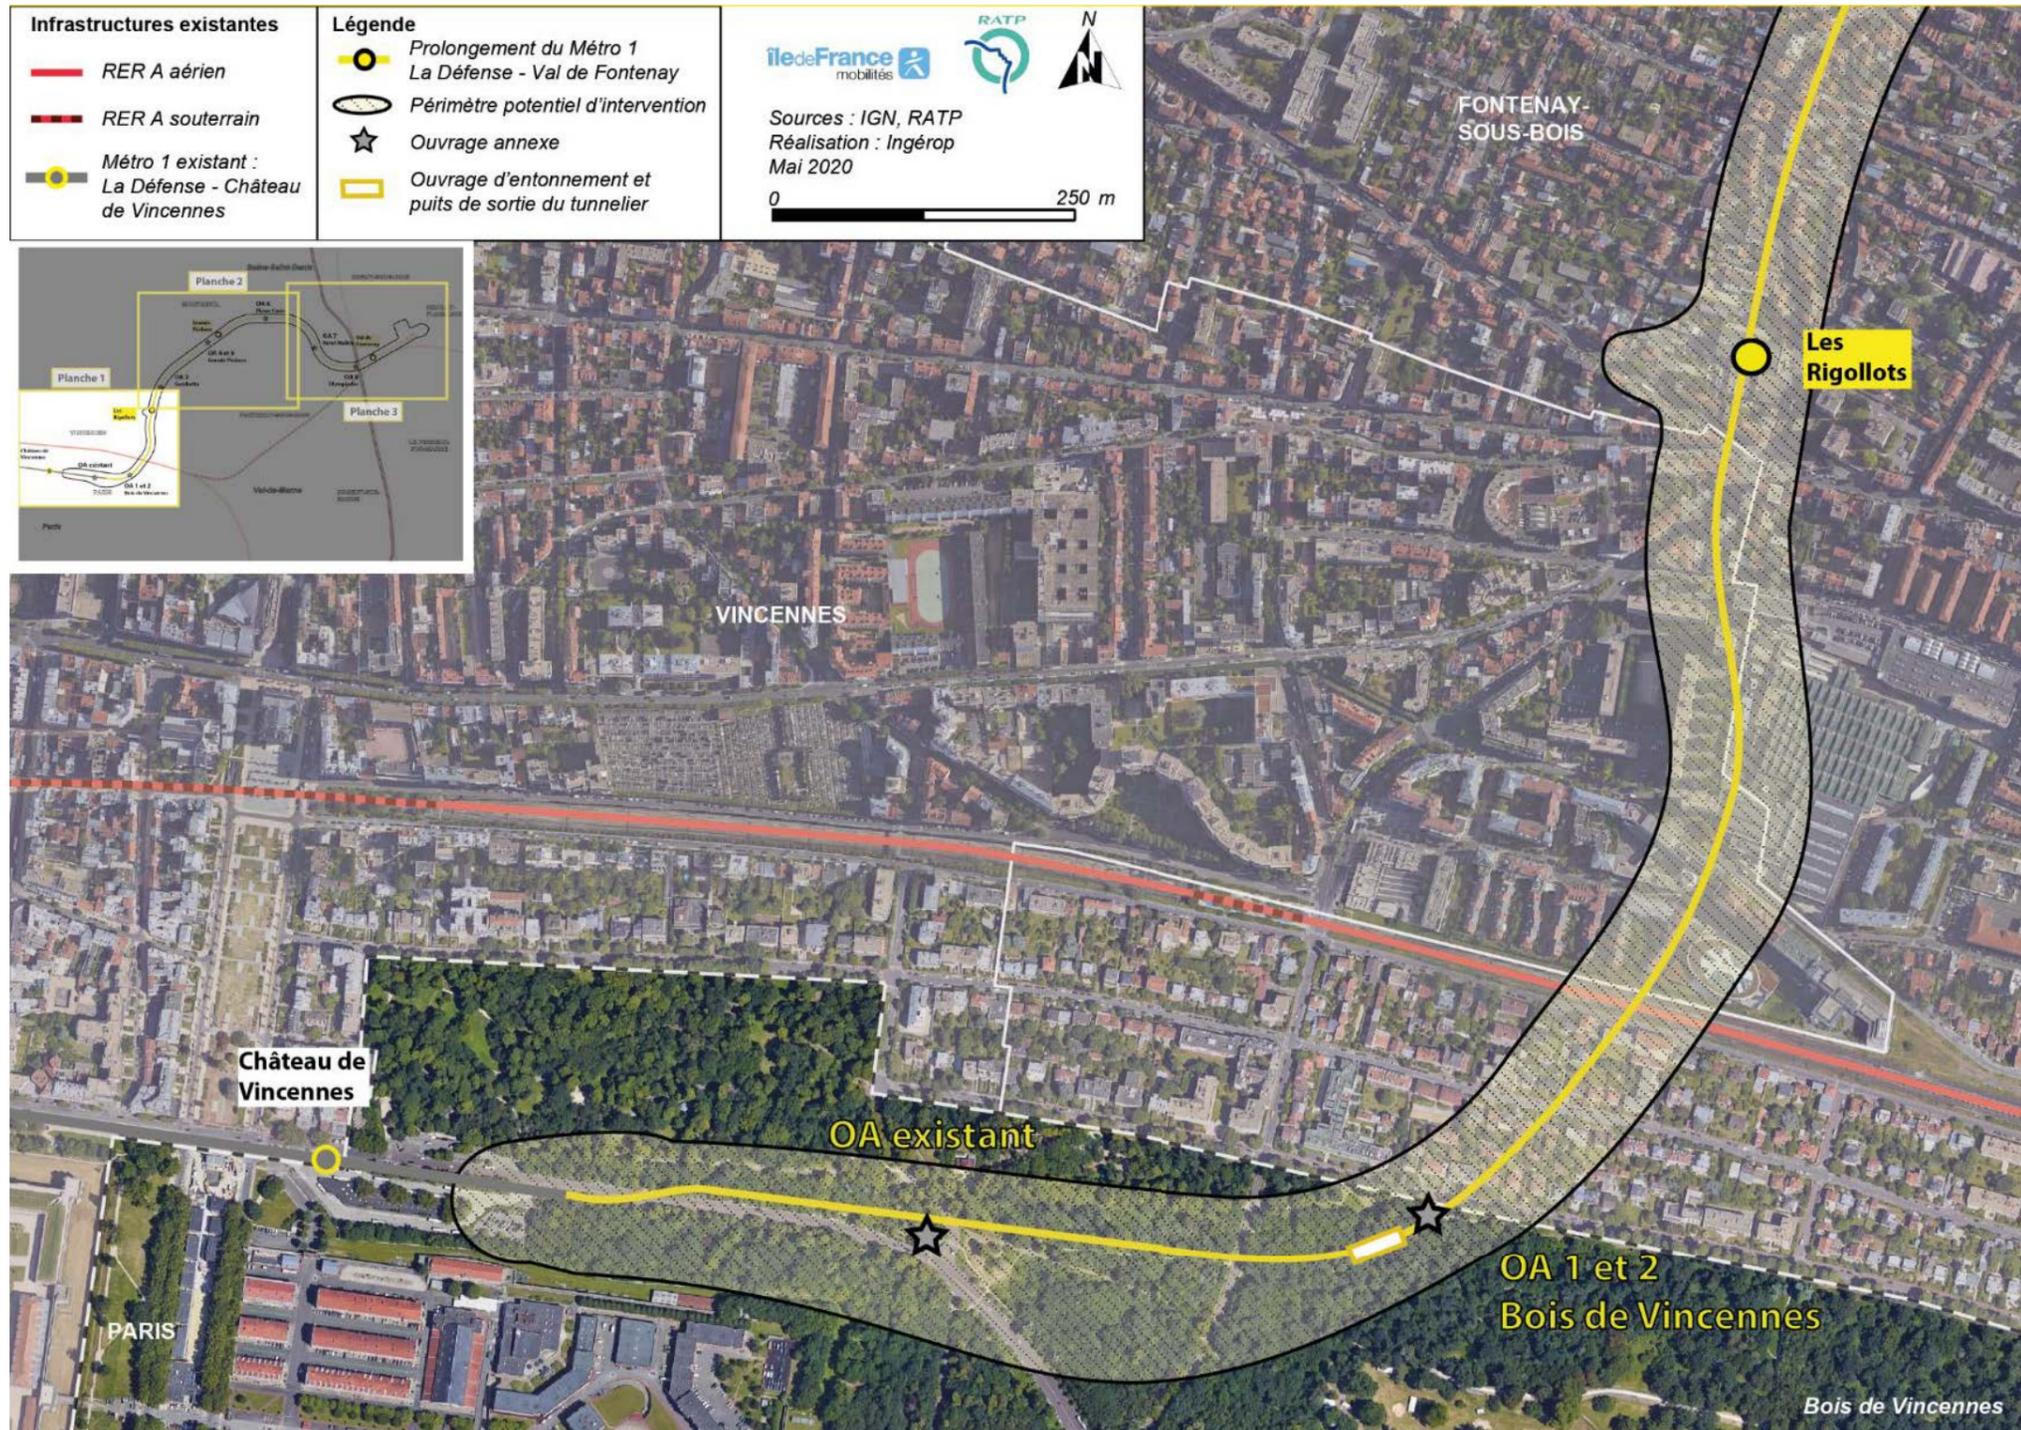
Détail du Plan Général des Travaux sur la commune de Paris (Source RATP / INGEROP)
